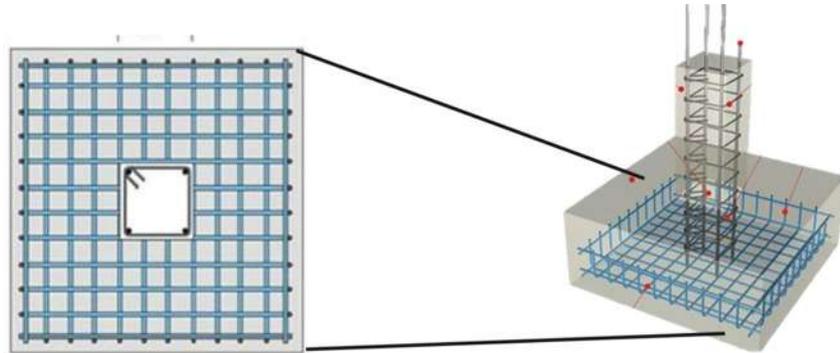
zapata aislada de un concreto armado. [www.mismateriales.com](http://www.mismateriales.com)
